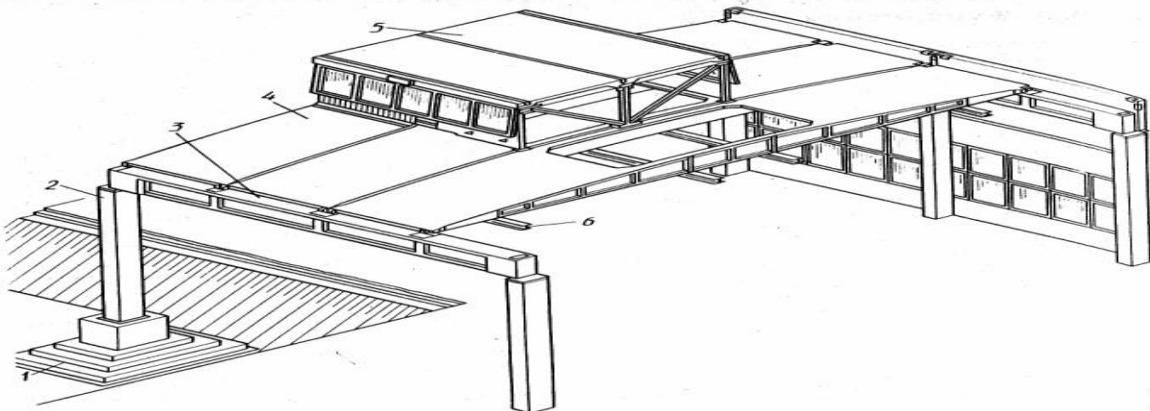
Залізобетонний каркас з кроквяними балками:
